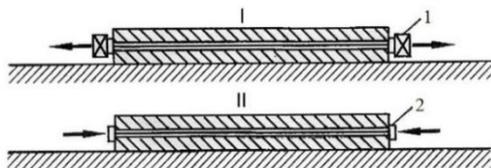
Схема создания предварительного натяжения арматуры на бетон
